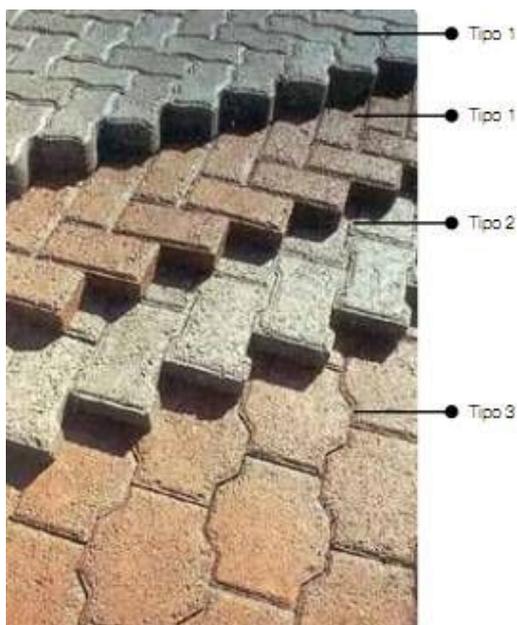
Tipos de Pavimentos Intertravados.
